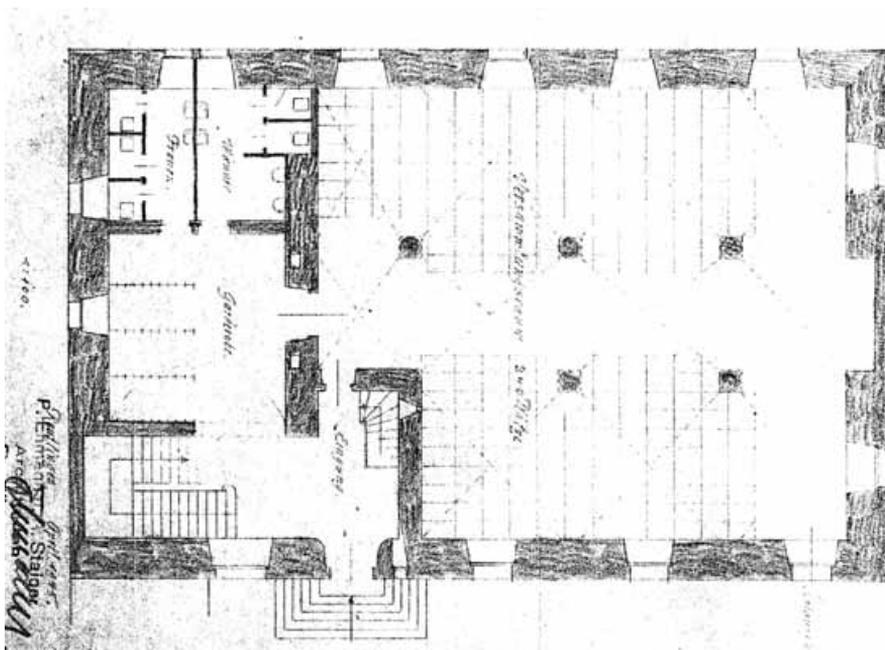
Erdgeschoss-Grundriss Zwiefalterhofstraße 4, 1945. Planung eines kirchlichen Versammlungsraumes mit 240 Plätzen durch die Reutlinger Architekten Paul Ehmann und Albert Staiger.
